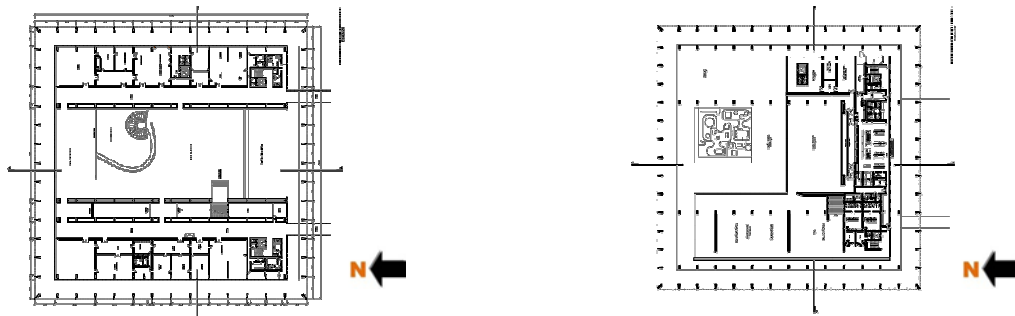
Planta do Segundo Pavimento. Foto 4 – Planta do Terceiro Pavimento. Fonte: Marco Aurélio da Silva Máximo e Ministério das Relações Exteriores – MRE.
